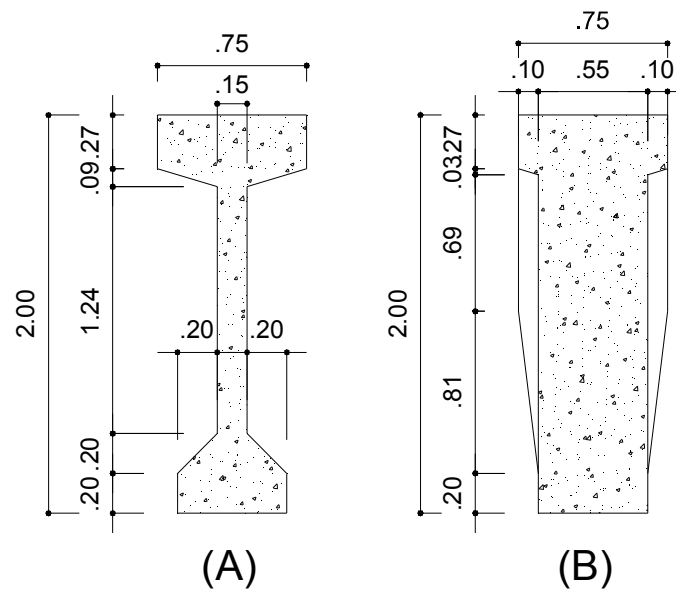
Seção em “I” das longarinas e suas dimensões: figura A - corte no meio do vão; figura B – Corte sobre o apoio.
